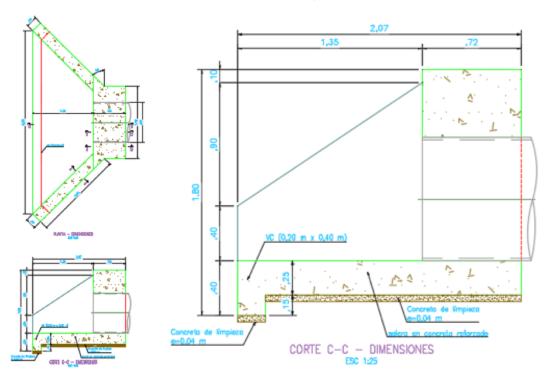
Detalle Cabezal Tipo – Placa Huella
